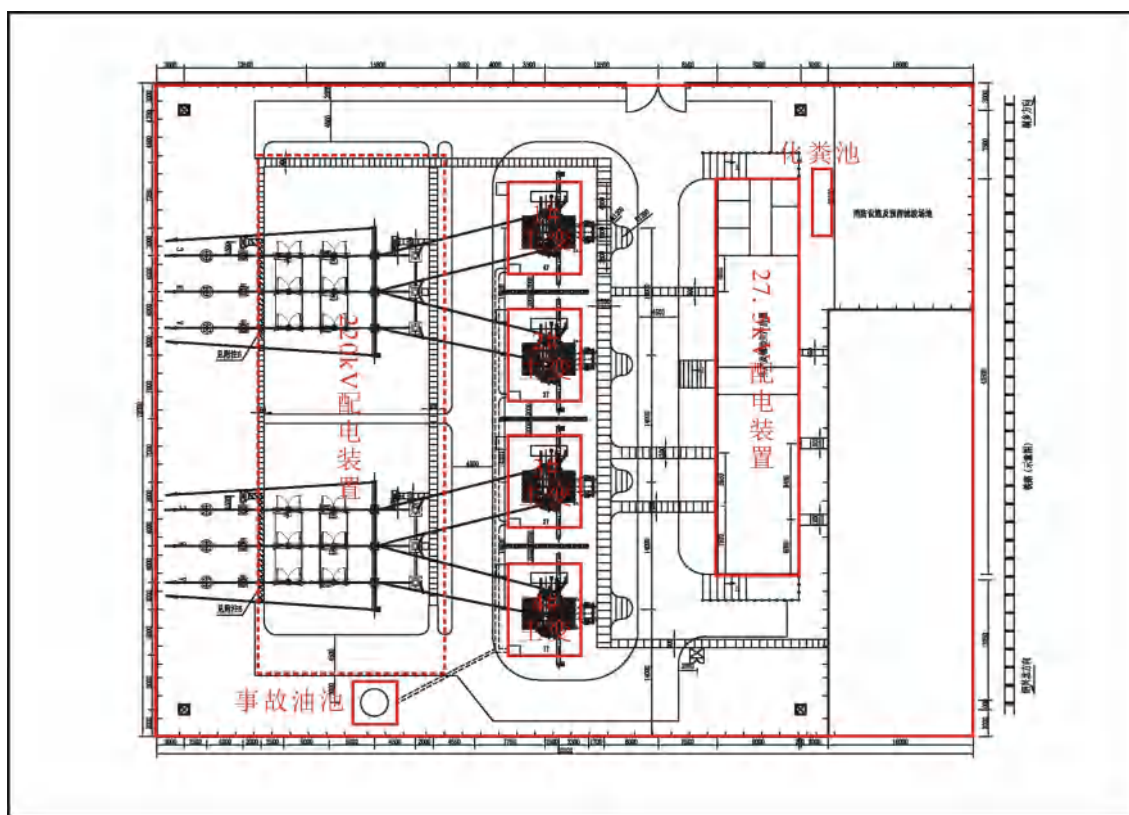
220kV 桐乡、萧山 2#牵引变电所总平面布置图（户外变电所）
